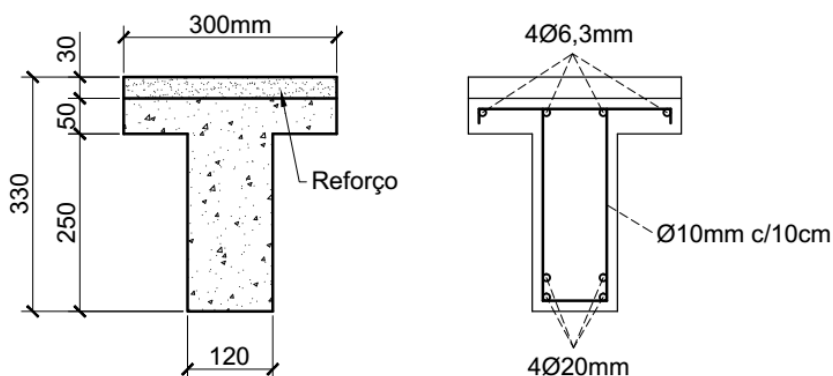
Detalhamento das vigas ensaiadas (REIS, 2003).
